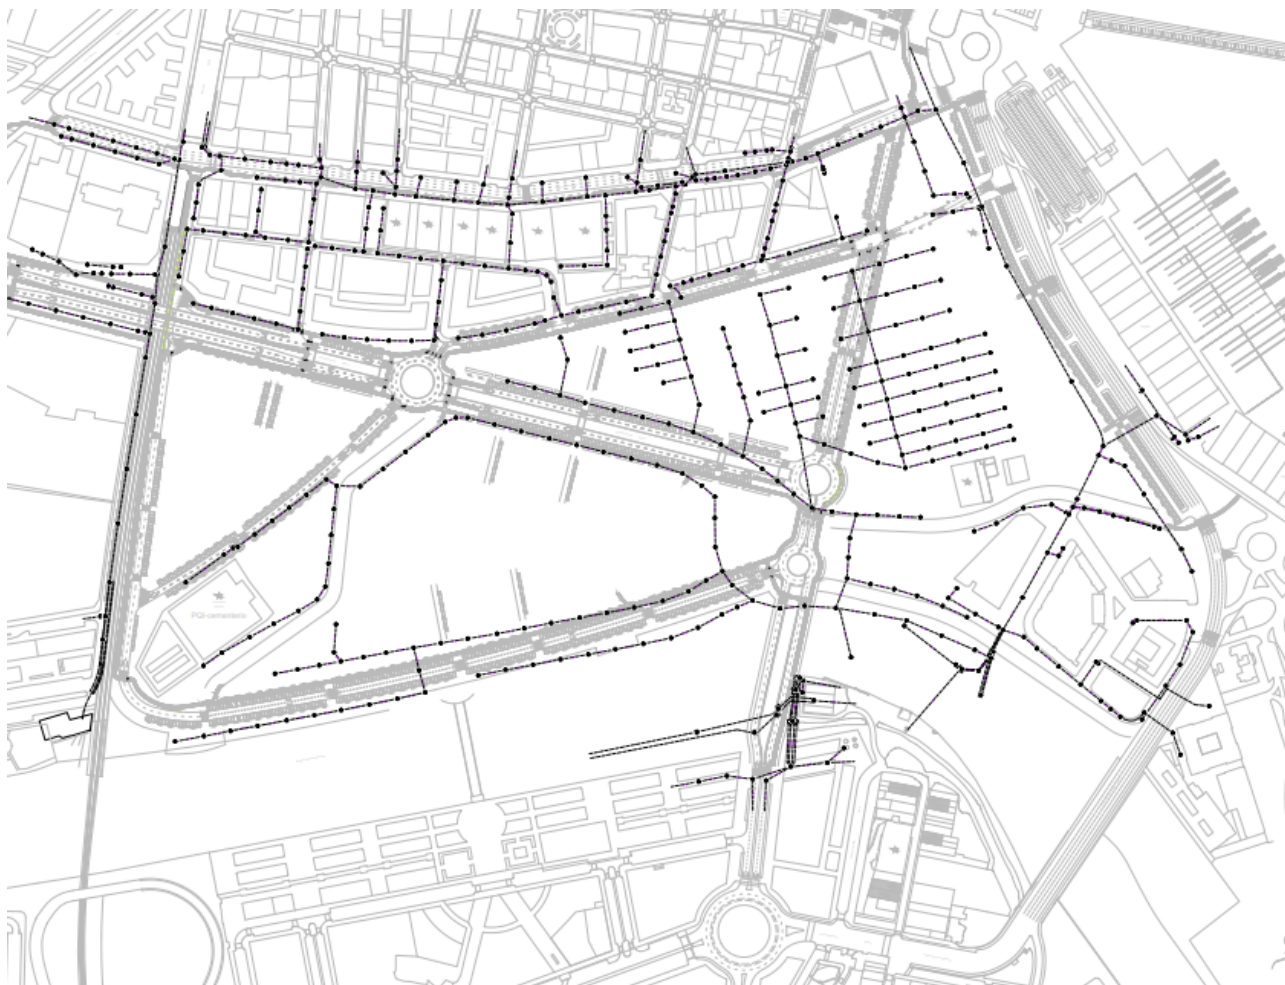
Planta de situación de las redes existentes tanto dentro del ámbito como en su entorno.
